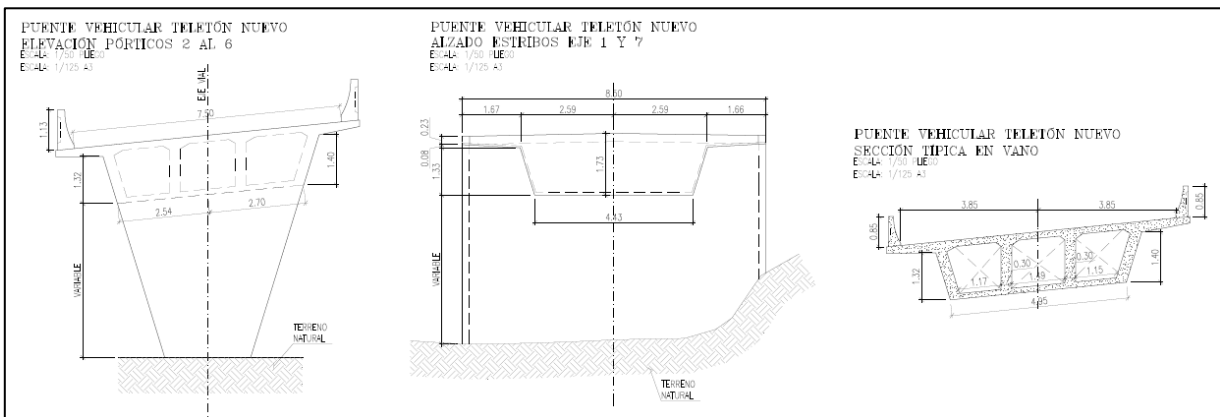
Vista General Puente Teletón Curvo Estribos Y Pilas
